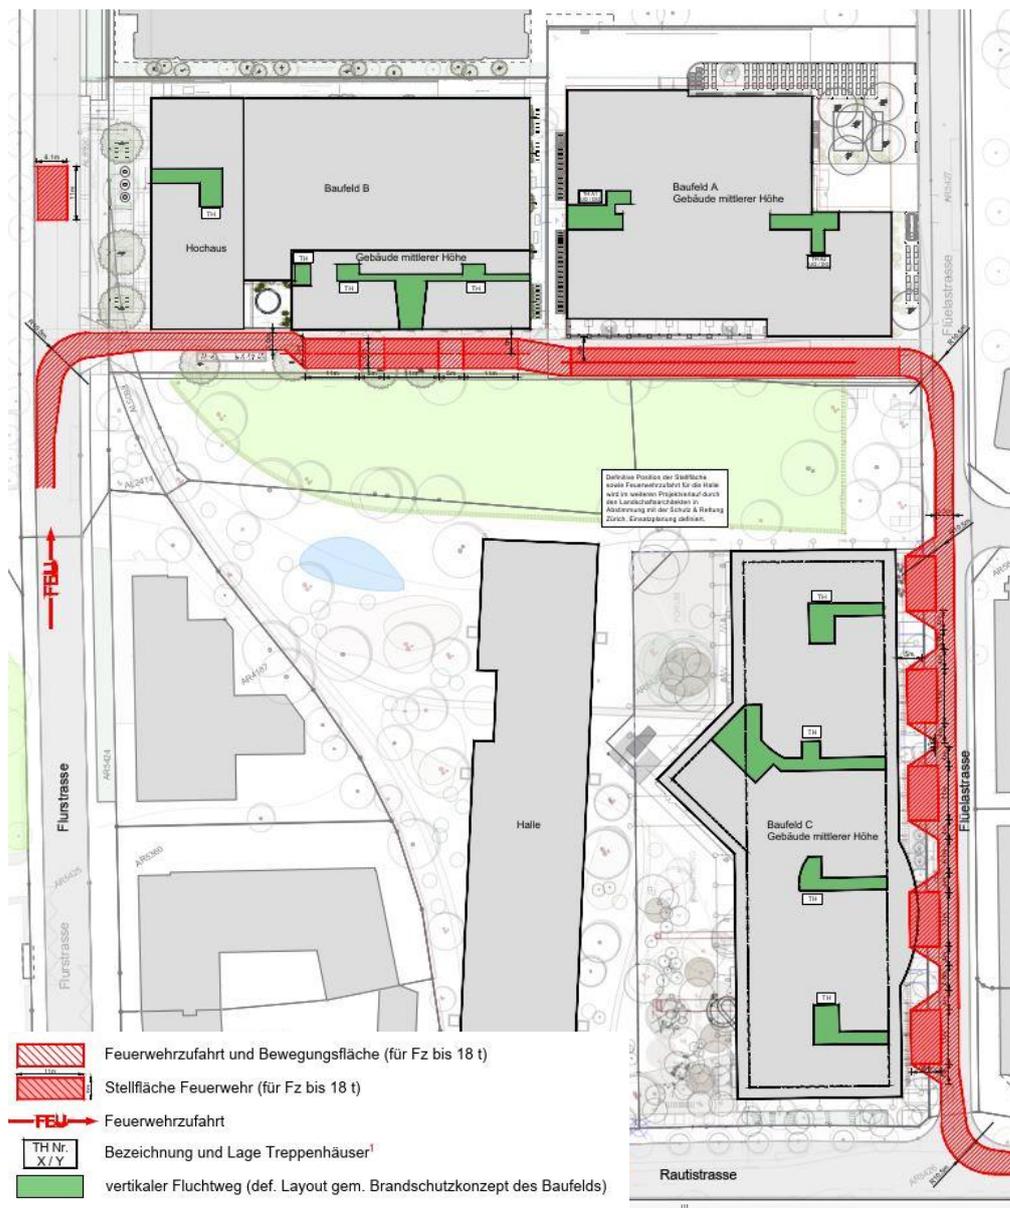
Brandschutzplan, Gruner, Februar 2020
